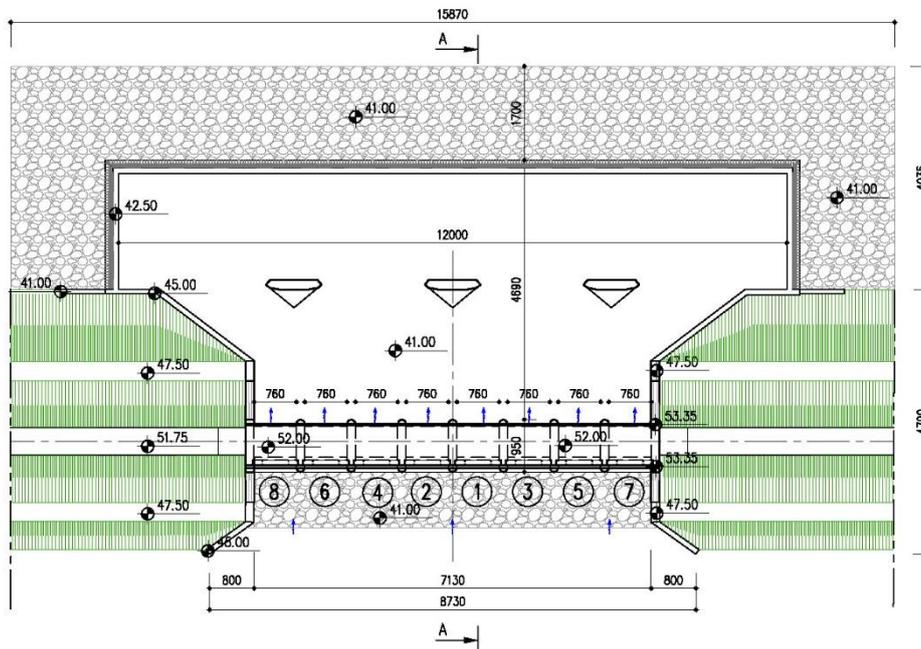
Pianta del manufatto di alimentazione dell'invaso laterale.
